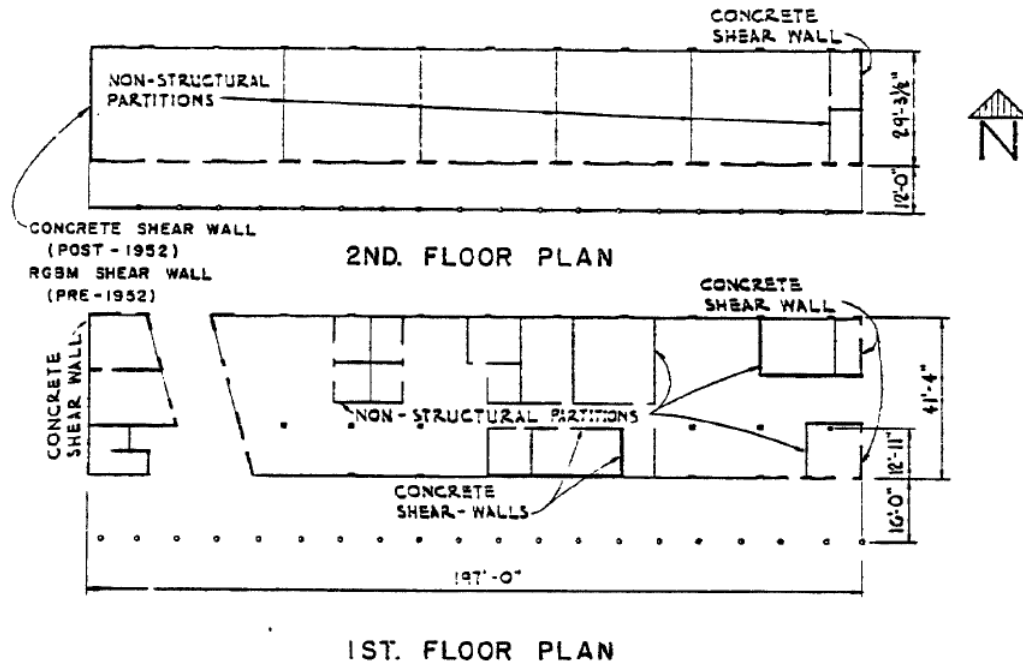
Vistas de plantas del Edificio Arvin High Shool.
